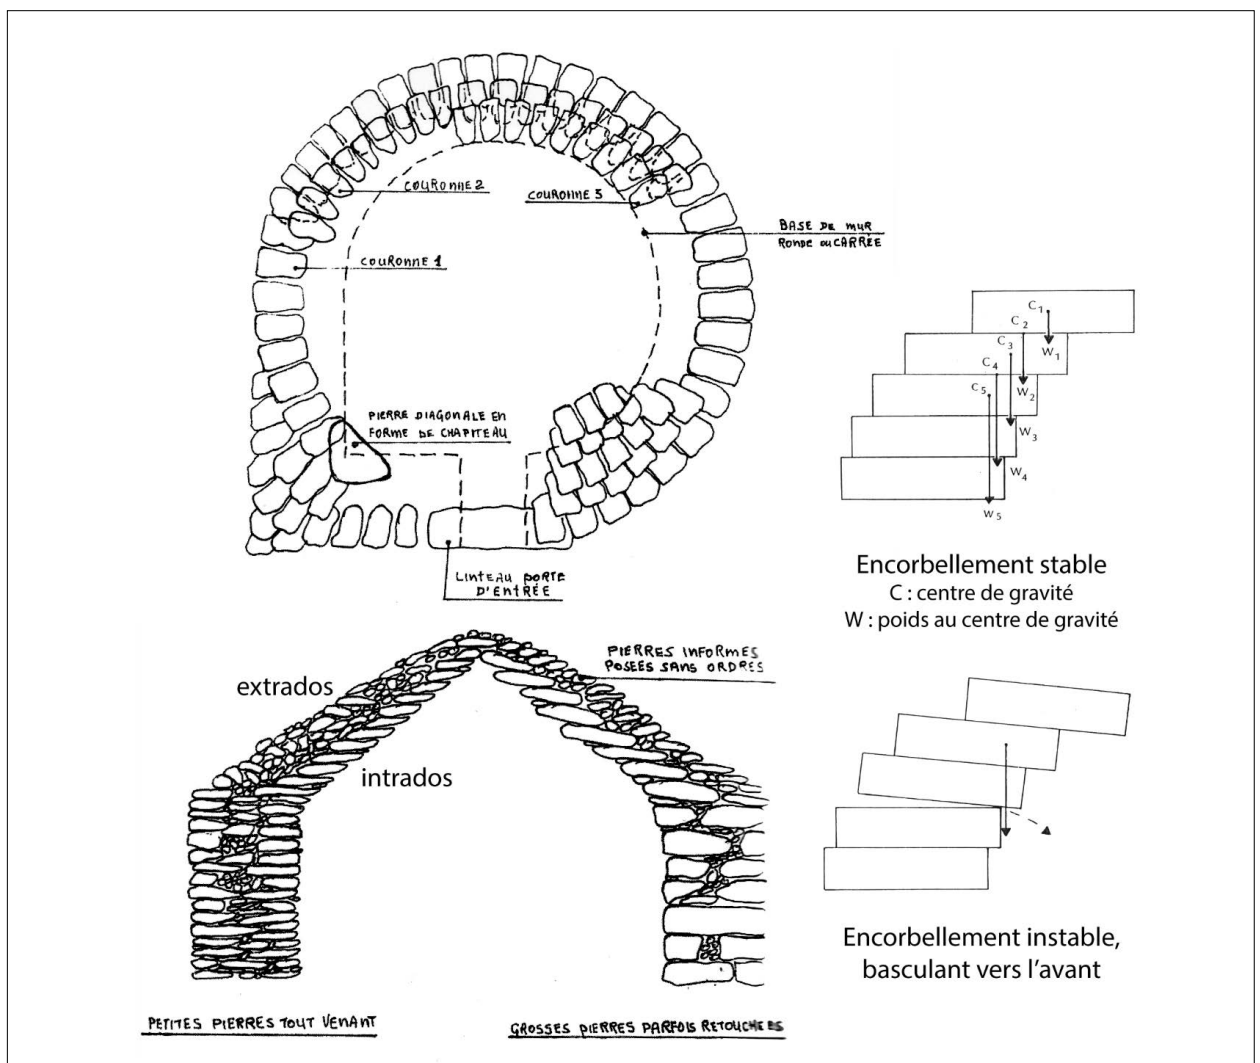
Gauche: Plan et coupe d'une voûte en encorbellement pour les architectures vernaculaires (d'après Roustan 2003), droite: Principe de stabilité de la technique de l'encorbellement (d'après Cavanagh et Laxton 1987).
